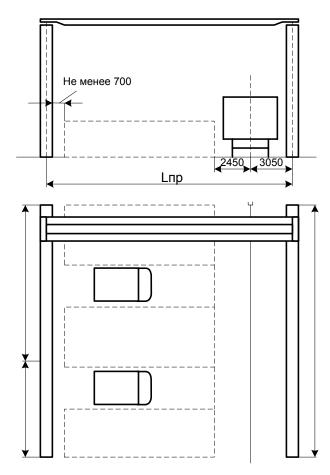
Поперечный разрез и план открытой площадки с мостовым краном (автопроезд – поперечный)
